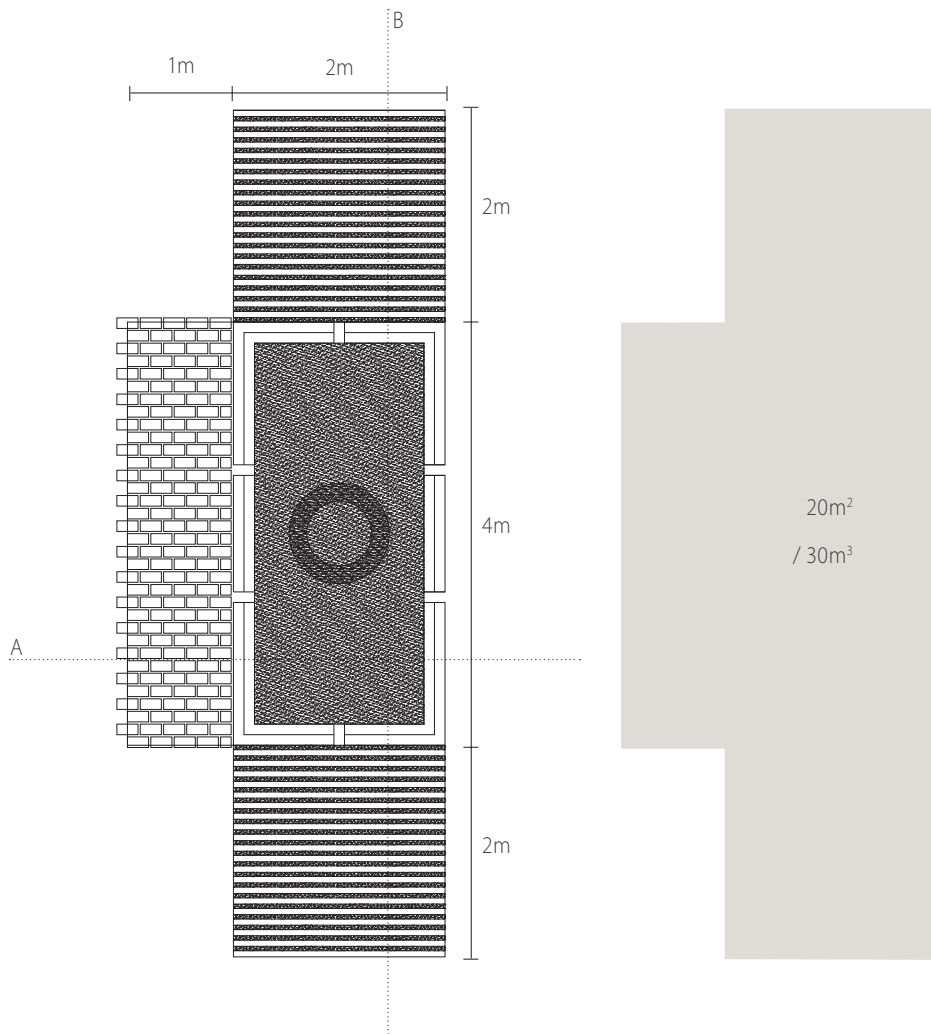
Detailansicht Bauweise 2: Draufsicht
